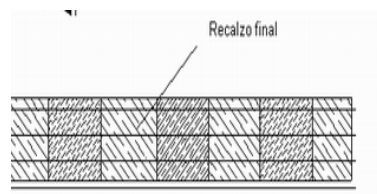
Construcción Muro Armado en pozos 2 y recalce de pozos 3 y construcción del muro en el pozo 3.
